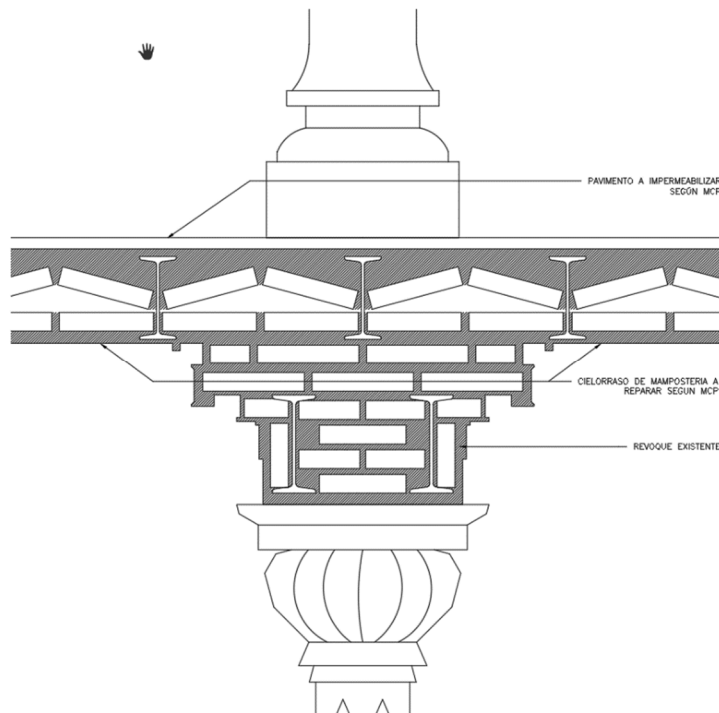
Detalle de cielorraso de mampostería original, a rehabilitar en esta instancia.
